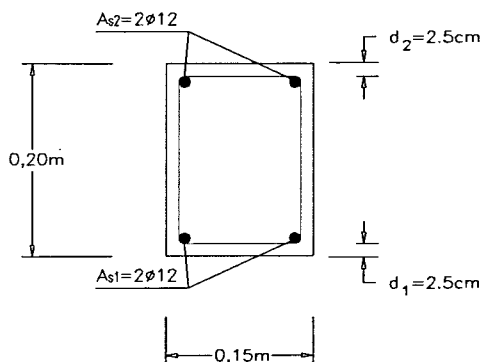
Secção da viga e representação das armaduras longitudinais adoptadas
